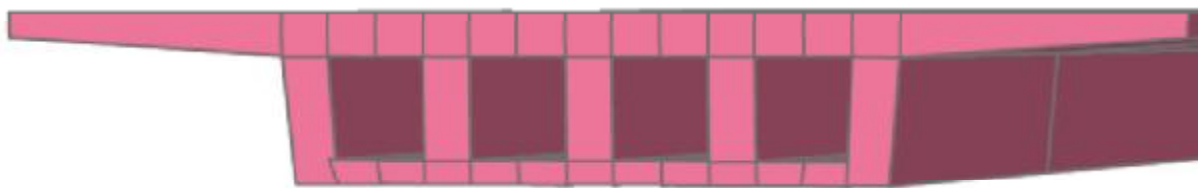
Modelo Estrutural – Longo prazo – secção vazada do tabuleiro
